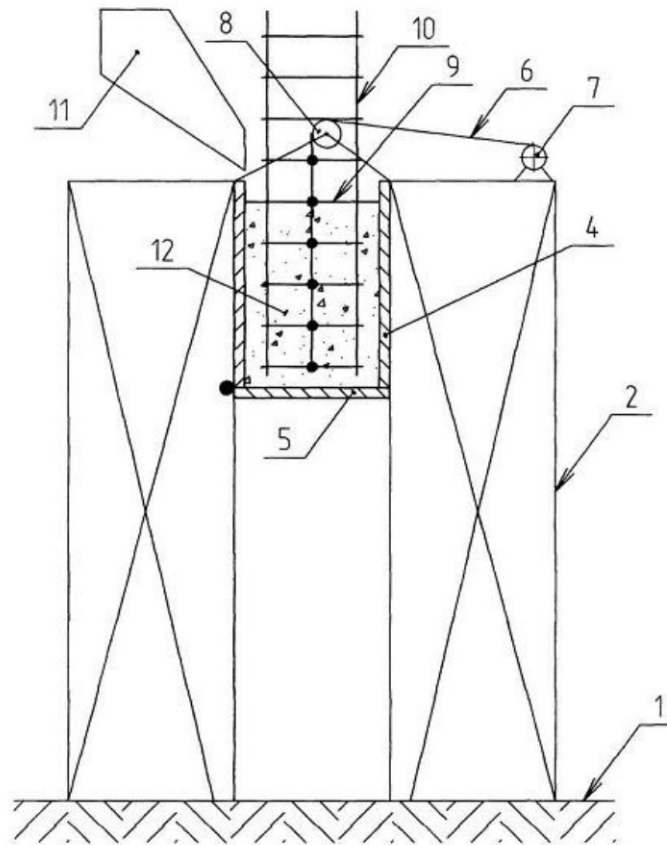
Спосіб зведення монолітної будівельної конструкції. 1 — рівень ґрунту; 2 — риштування, що несе опалубку; 3 — споруджувана будівельна конструкція; 4 — нерухома опалубка; 5 — шарнірне днище; 6 — трос, приєднаний до каркаса; 7 — лебідка з гальмом, яка регулює швидкість опускання; 8 — відхиляючий блок; 9 — верхня проєктна відмітка, де трос відсікають; 10 — арматурний каркас; 11 — бетонна суміш, що формує ярус; 12 — перший затужавілий ярус, який служить тимчасовим опорним «днищем».
